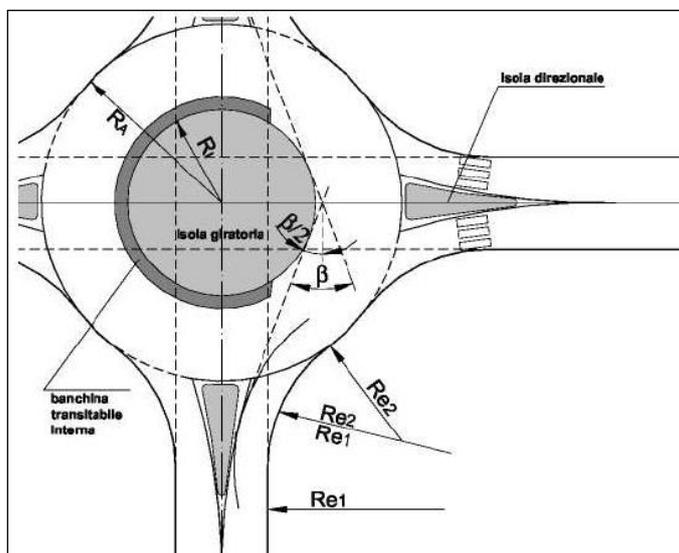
Elementi di progetto e tipizzazione delle rotonde
